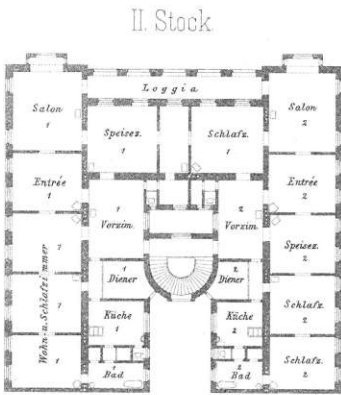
Grundrisse Zinshaus Jacquingasse 6 - Emil Förster, 1894
